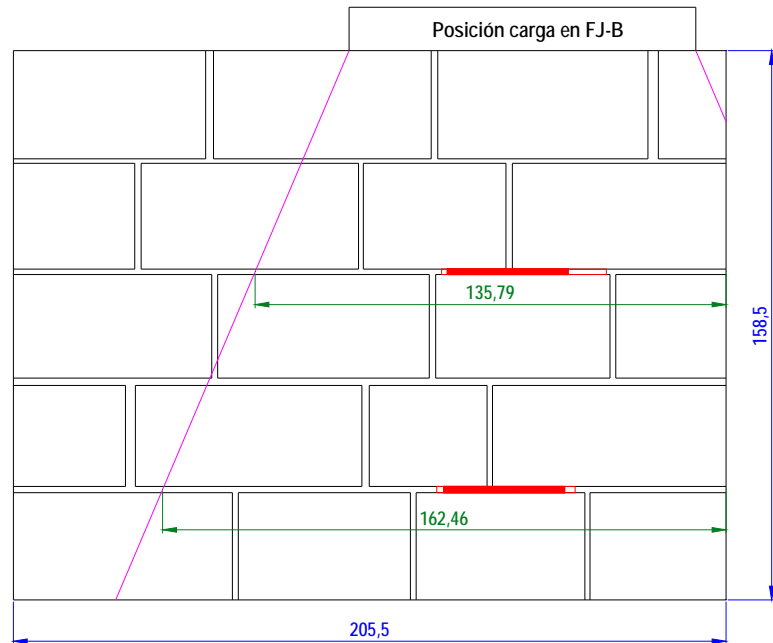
Ubicación de los ensayos de gato plano simple (corresponde al emplazamiento superior) y doble GPS-B en el alzado del muro de la sillería. Las cotas relacionadas están en cm.
